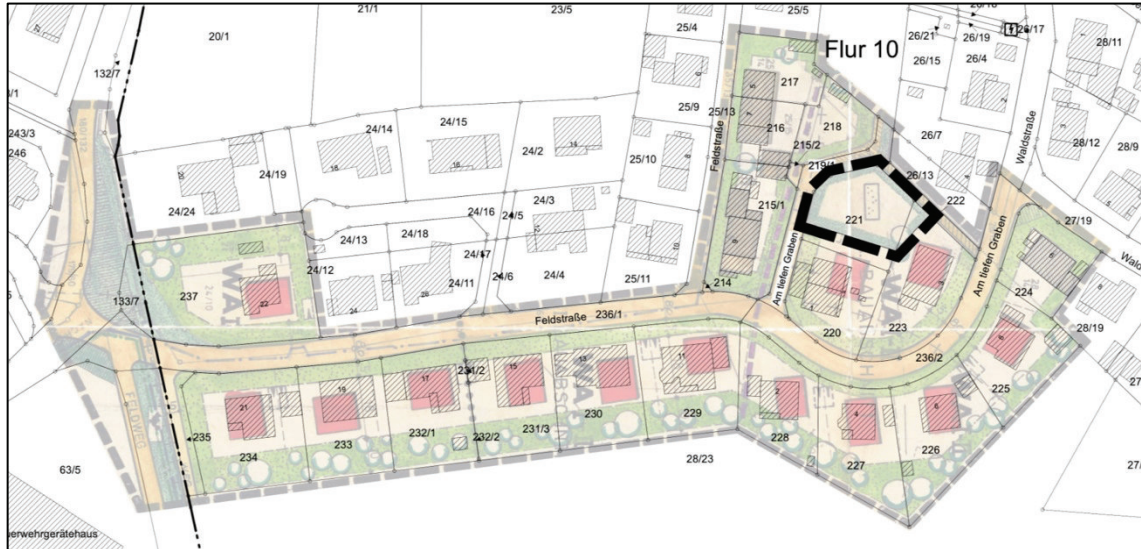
Teil-Bebauungsplan Nr. 3 - Planteil
